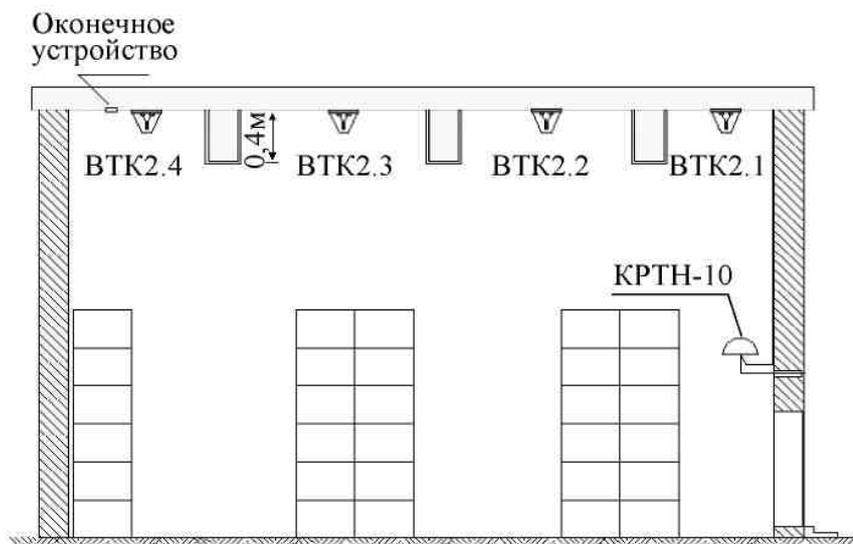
Размещение АПИ на потолке помещения с выступающими ребрами перекрытия.
